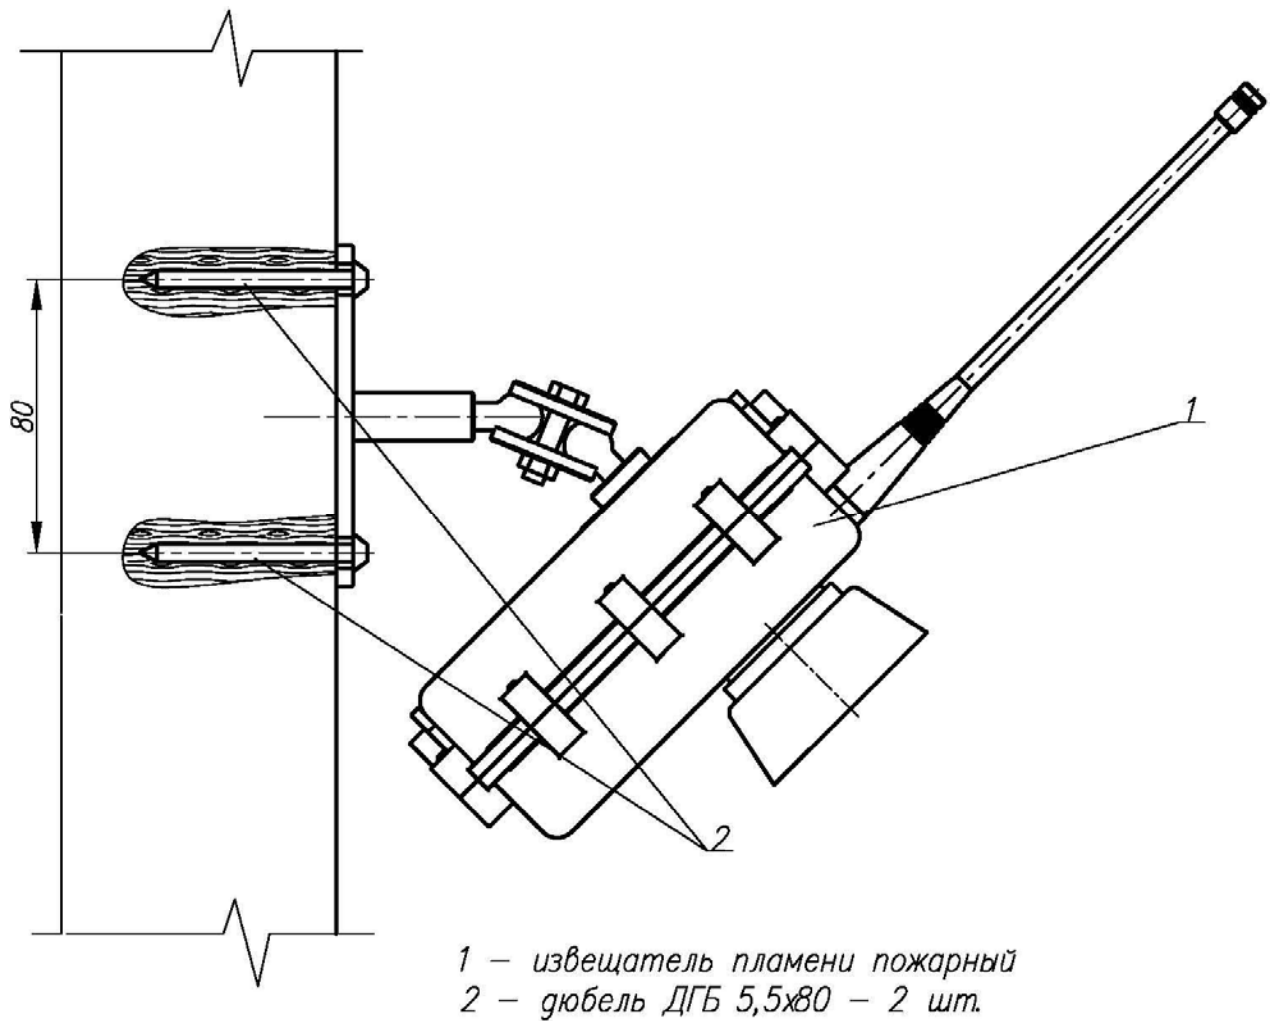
Вариант установки ИПП на железобетонной (кирпичной) стене
